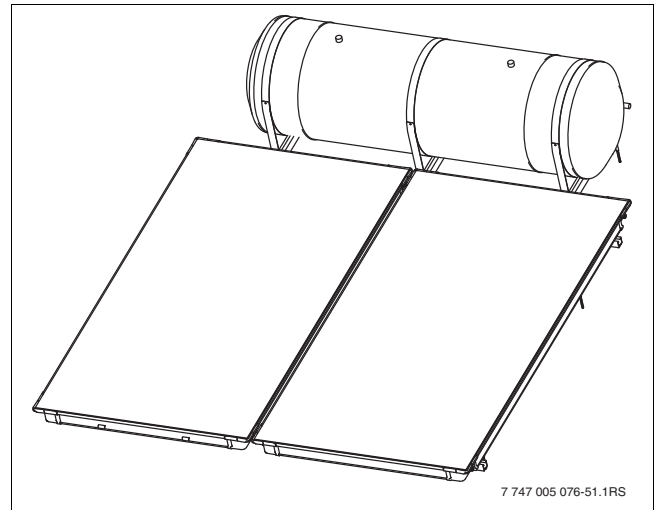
Vista montaje en tejado inclinado (sistema de 300 l)
